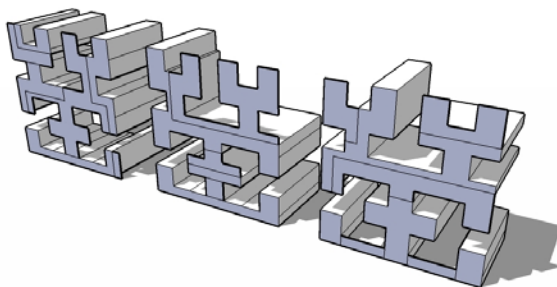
Seção extrudada da planta baixa (Do autor)
